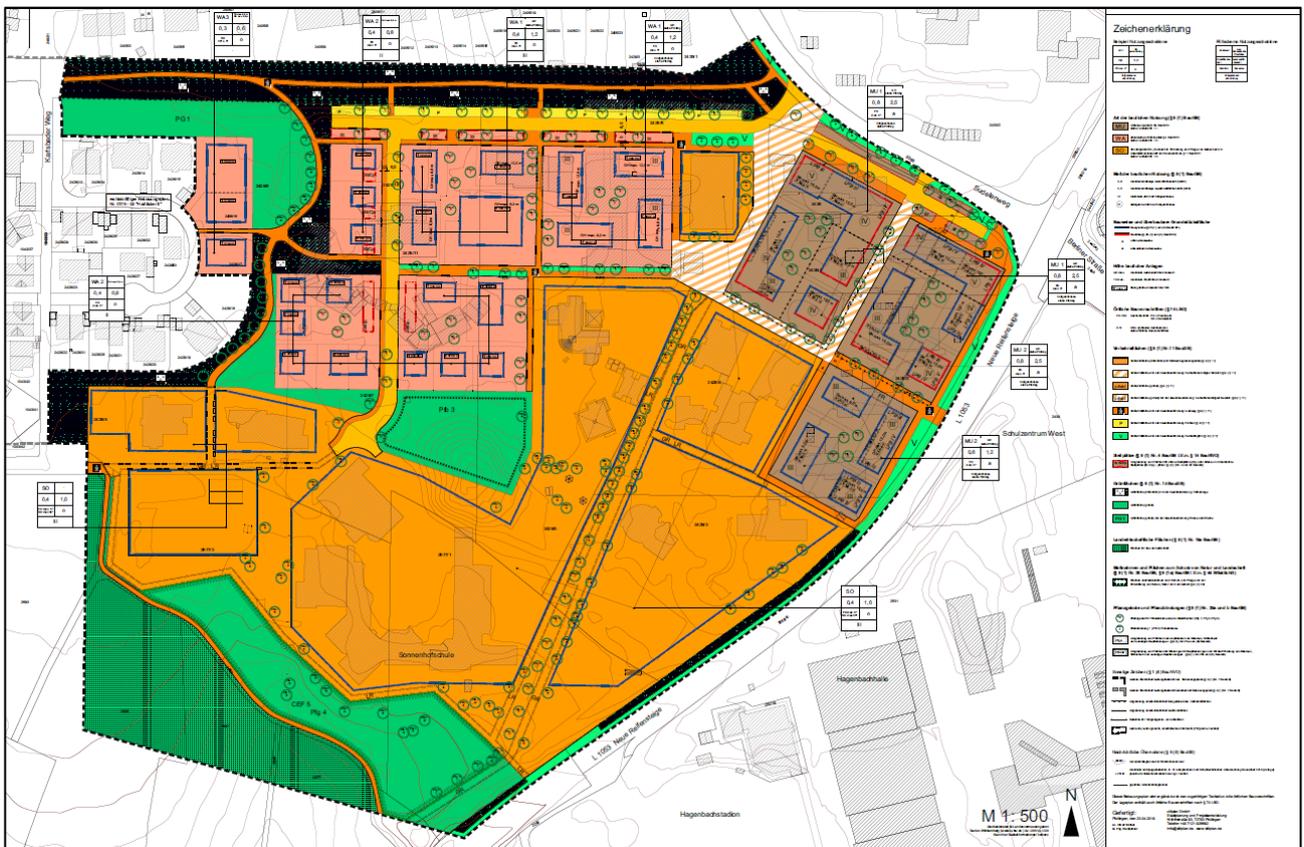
Bebauungsplan „Sonnenhof – 1. Änderung“, Entwurf 23.04.2019 (CITIPLAN)
